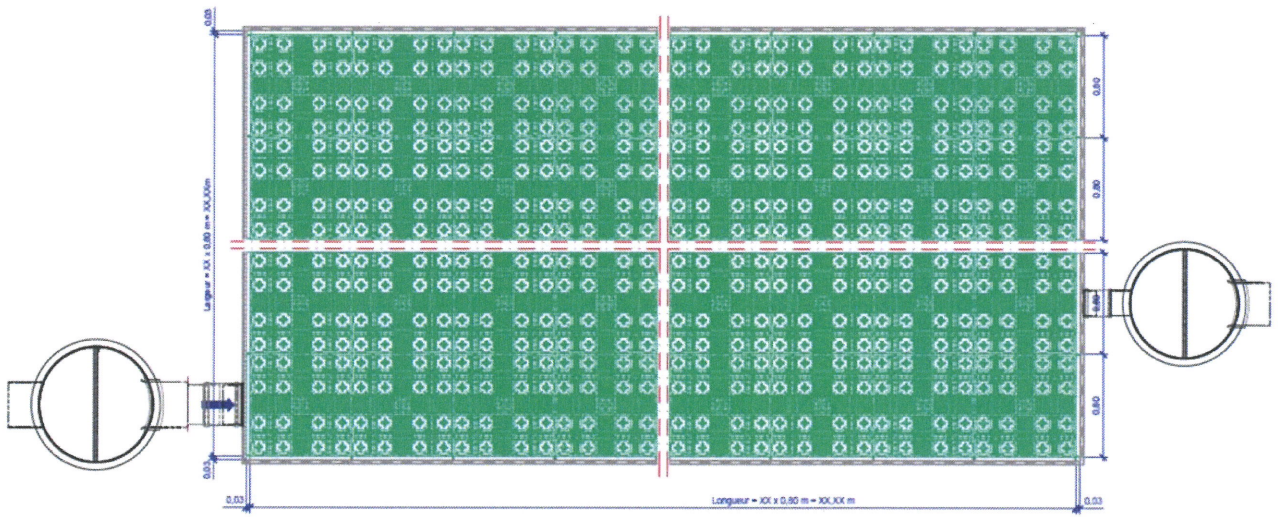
Coupe de principe d'un bassin réalisé avec Rigifill inspect et boîte d'inspection intégrée
